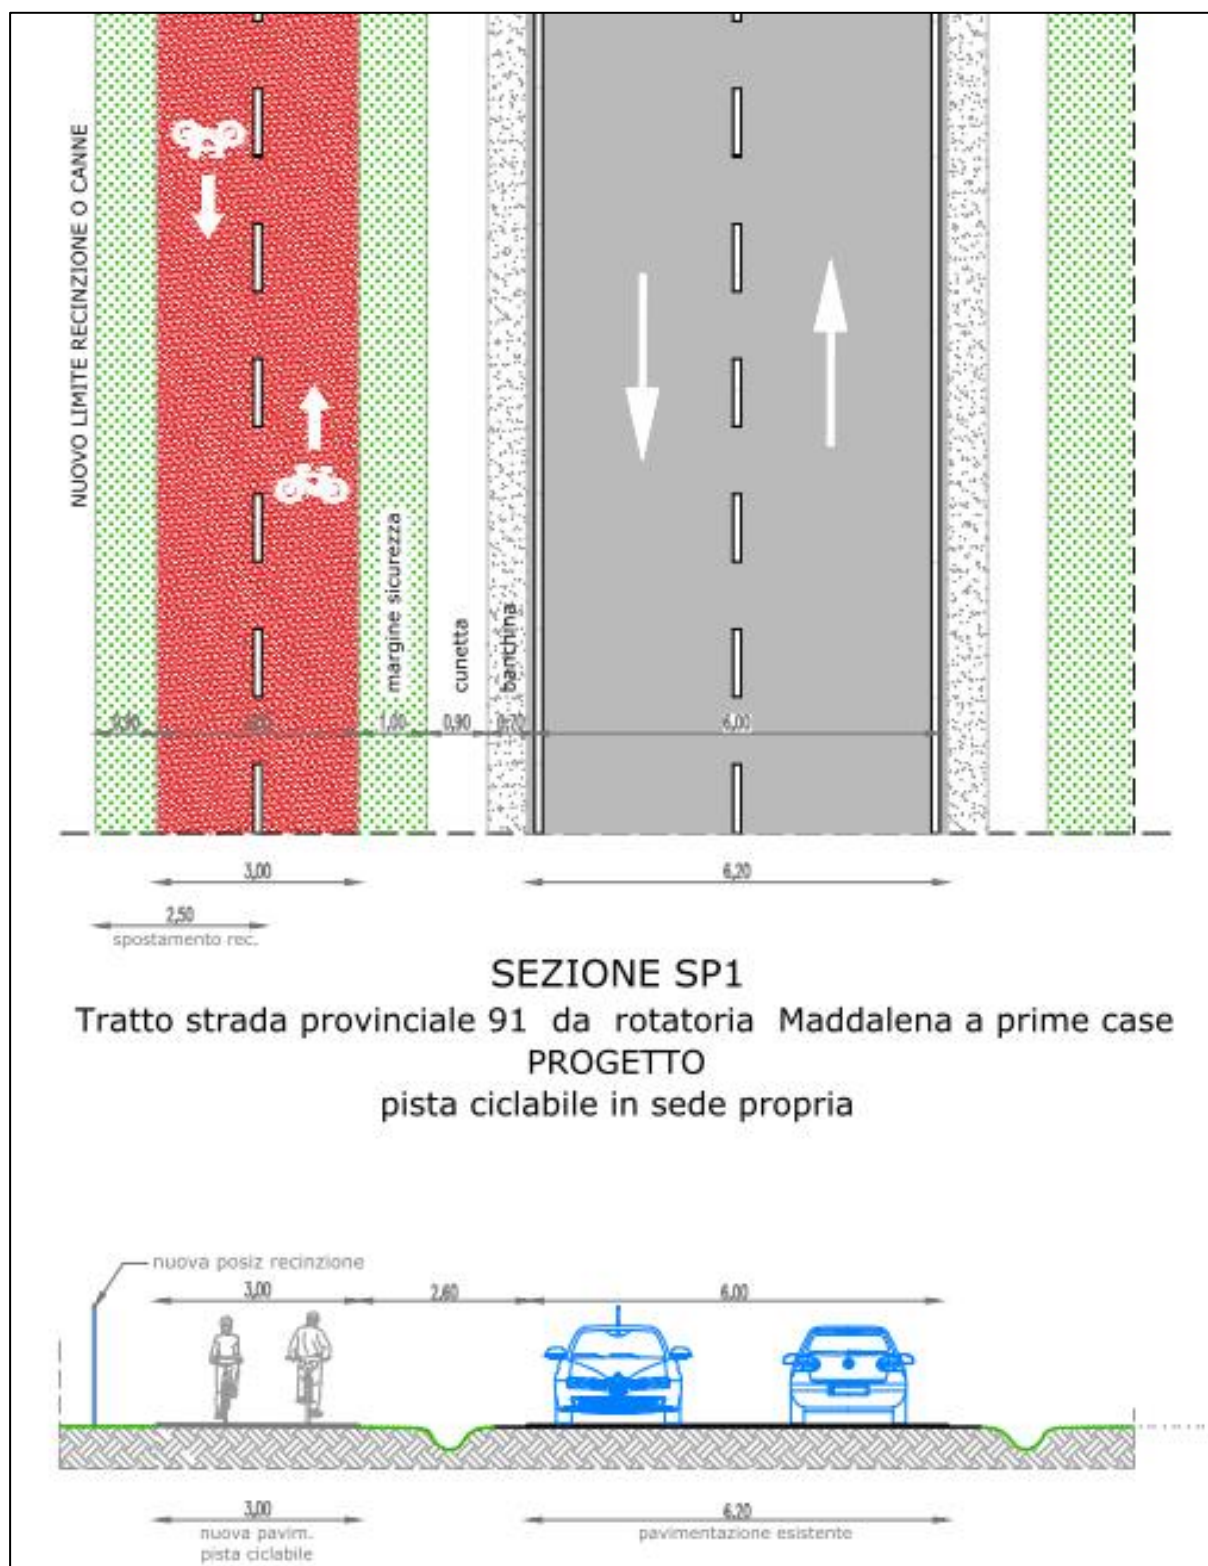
Sezione pista ciclabile [stralcio da progetto]
